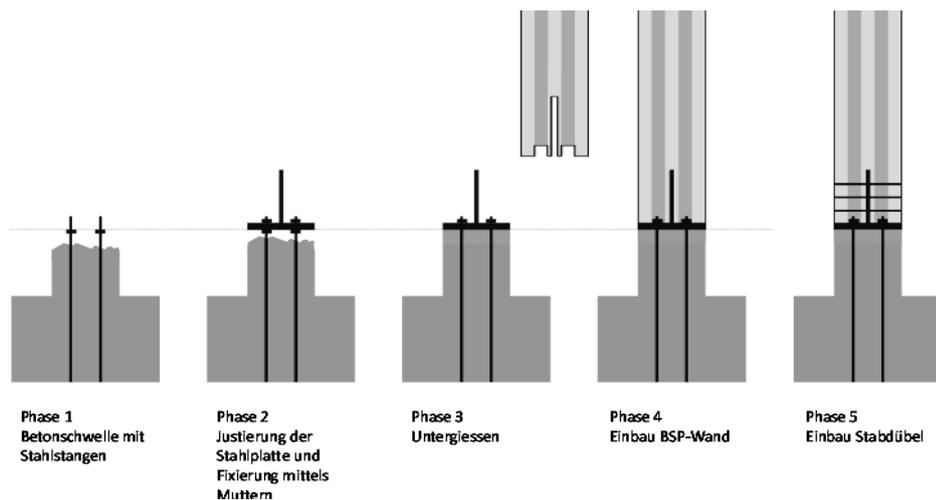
Montage de l'assemblage entre la fondation et la première paroi
